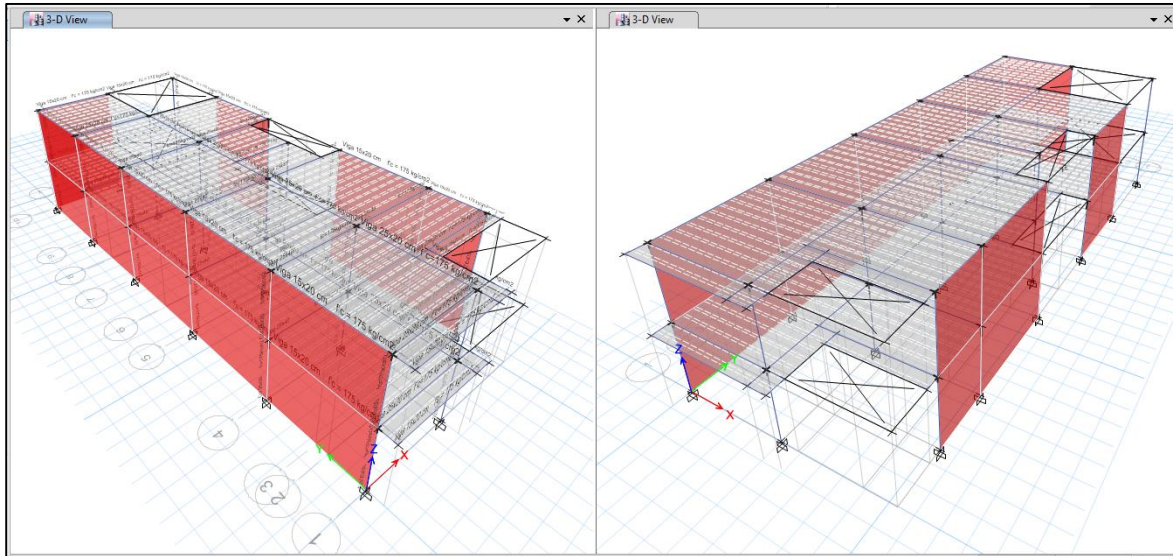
Modelo estructural de la situación actual de la vivienda 3 – Vista en perspectiva. Fuente: propia.
